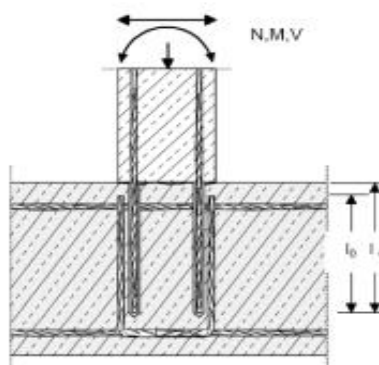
giunzione per sovrapposizione di pilastri sollecitati a flessione o muri a fondazioni.
